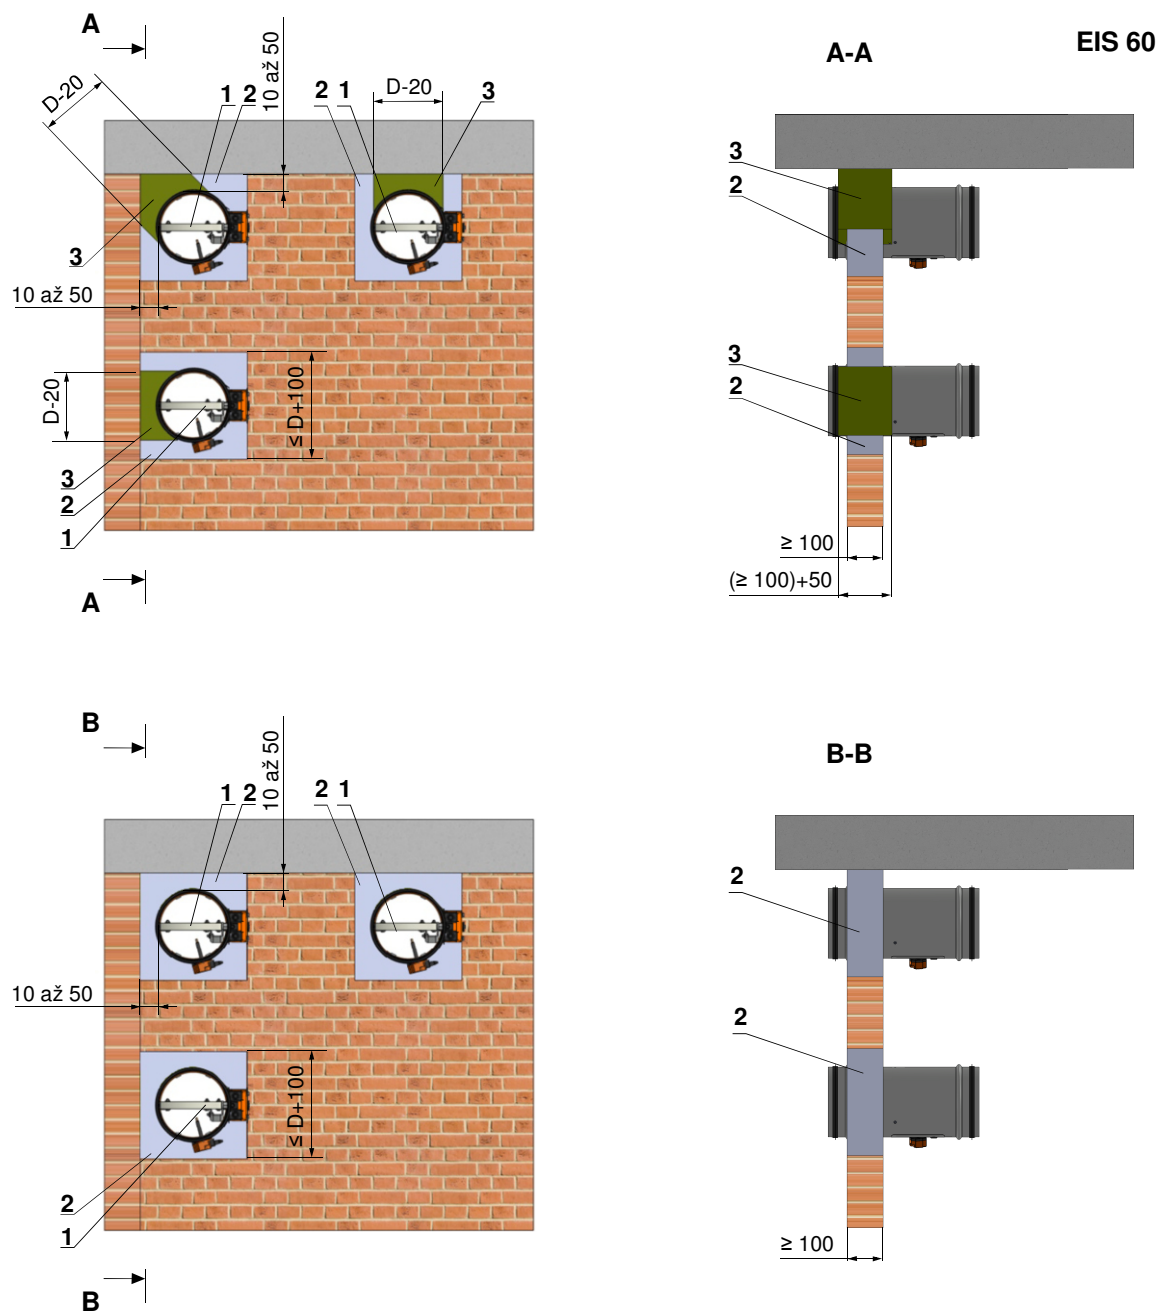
Tuhá stěnová konstrukce - sádra nebo malta
